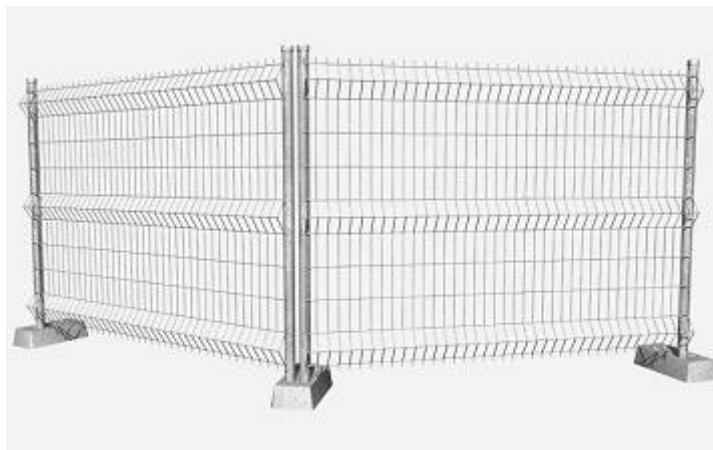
Imagem da vedação mais usada nas obras de infraestruturas urbanas
